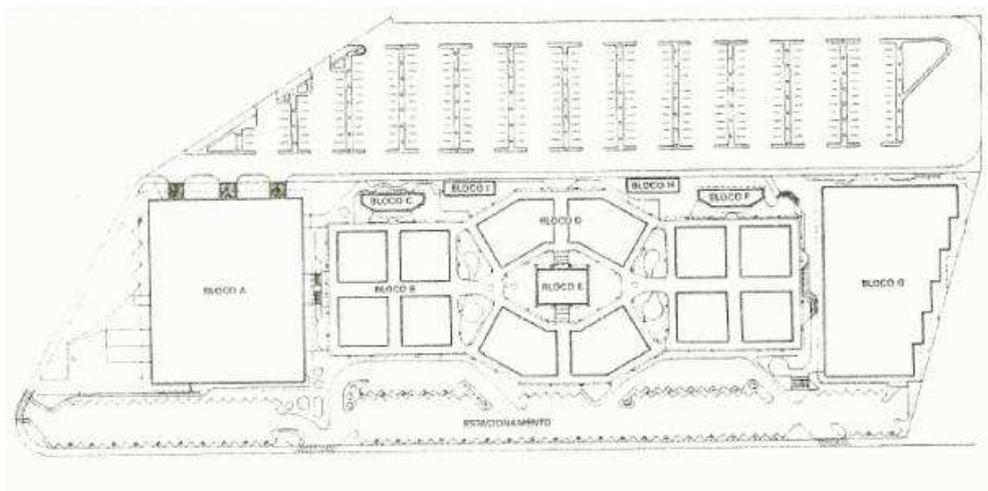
Planta de Implantação do Tropical Shopping Center.
